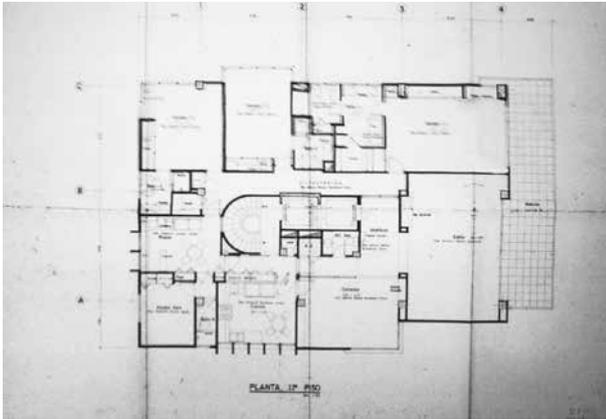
Planta piso 11avo, Edificio La Concha, Cartagena. 1986. Fuente Archivo Rafael Cepeda Torres.
